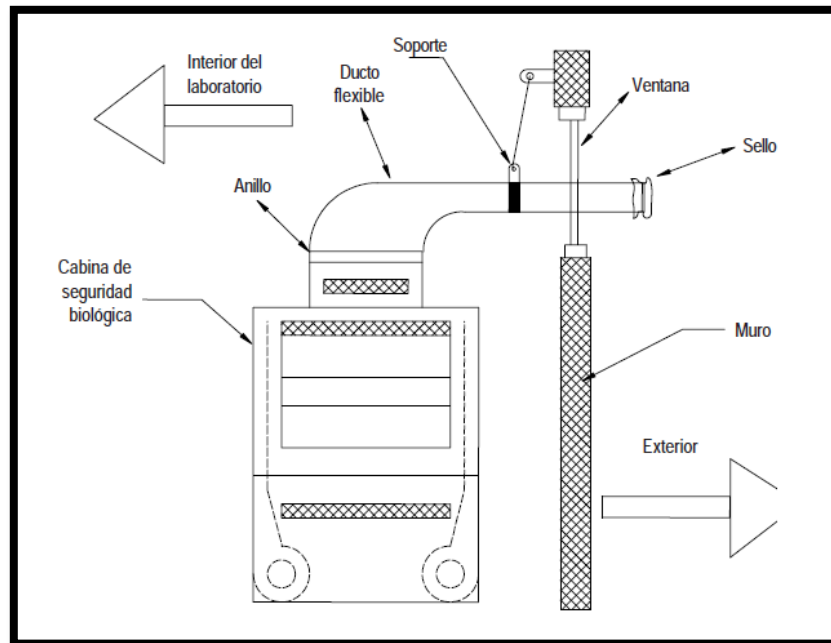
INSTALACION DEL DUCTO FLEXIBLE AL EXTERIOR
